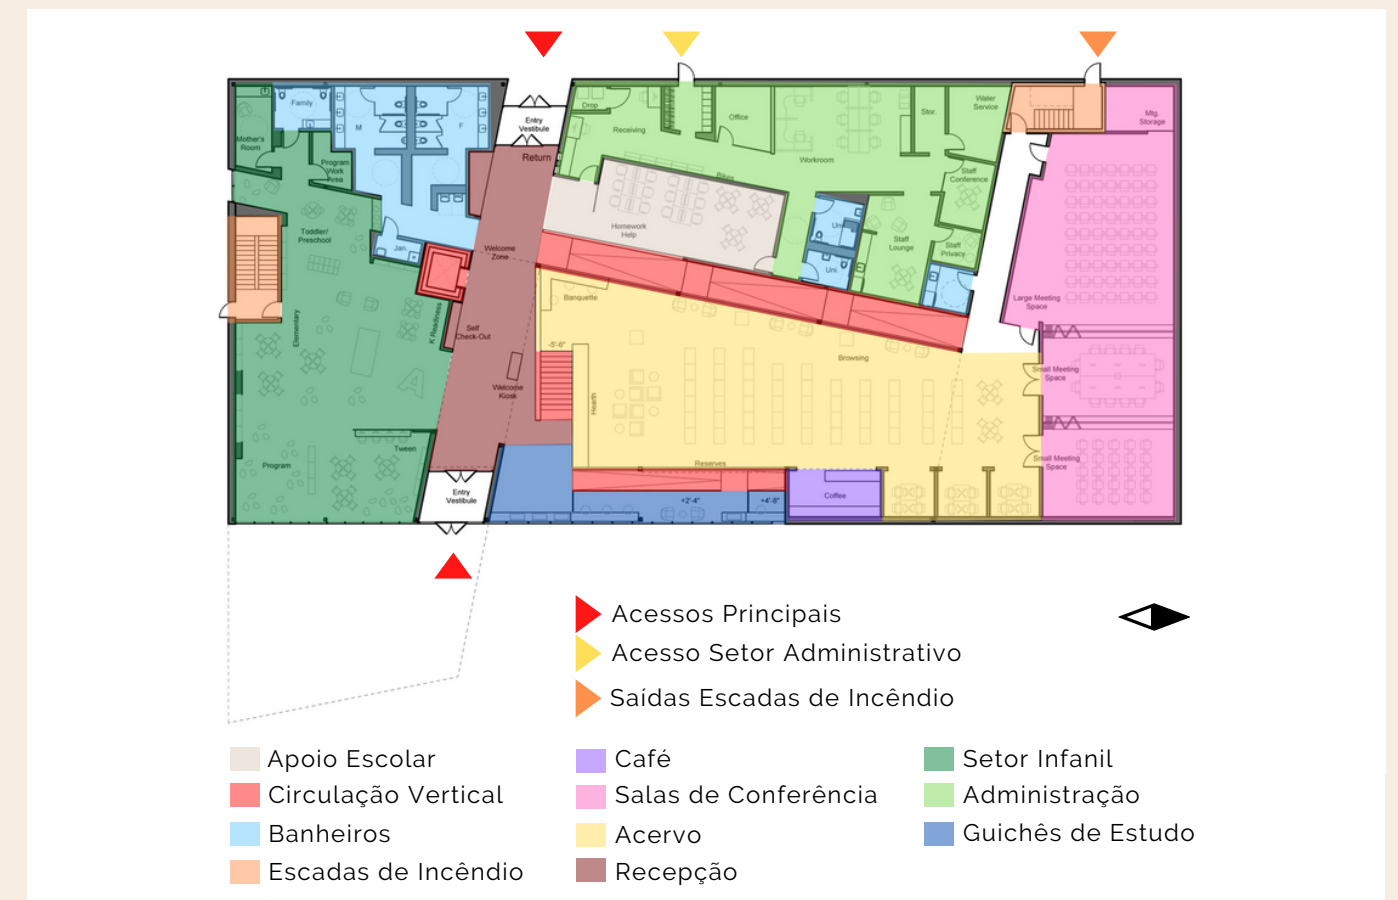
Setorização e Acessos do Pavimento Térreo da Biblioteca Northside.
